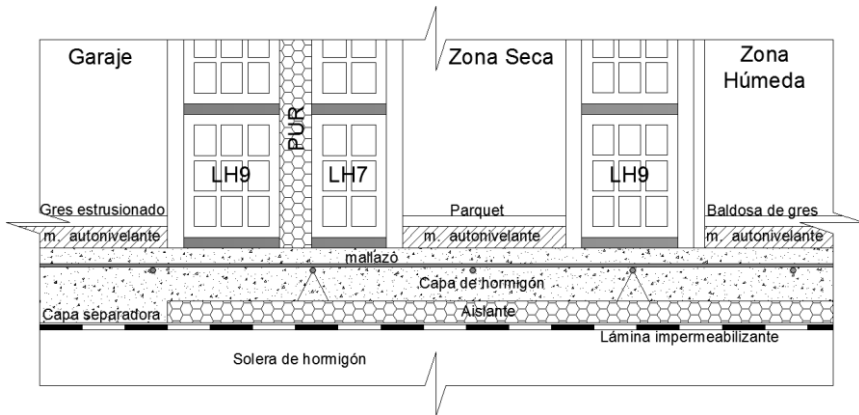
Detalle constructivo de las capas del suelo de la vivienda de planta baja. 2014. Elaboración propia.
